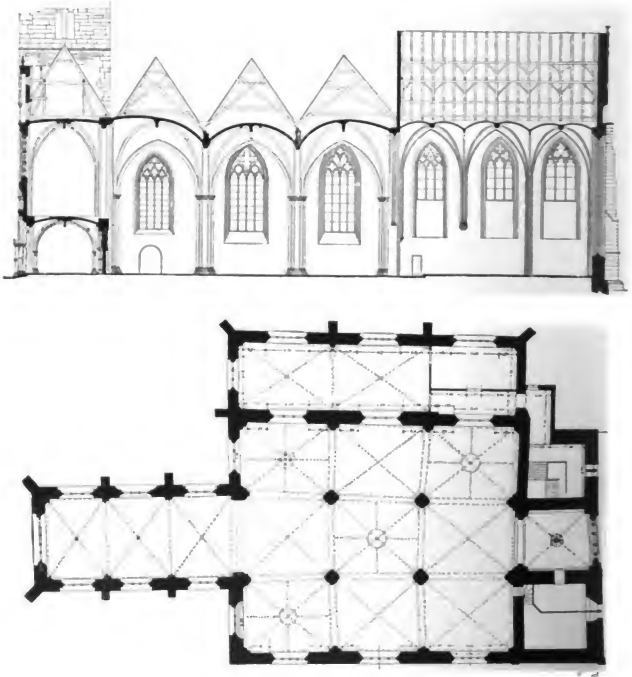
Grundriß und Längsschnitt der Liebfrauenkirche.
